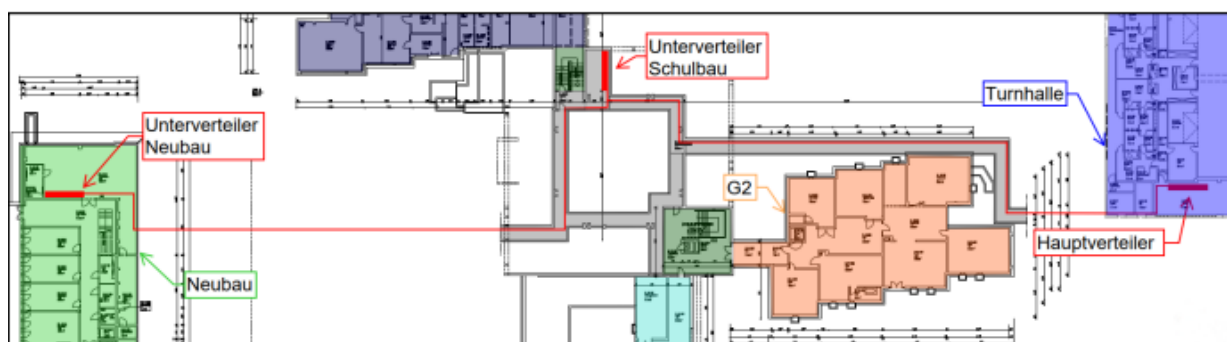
Erdgeschoss-Grundriss des Inda Gymnasiums (ohne Maßstab)
